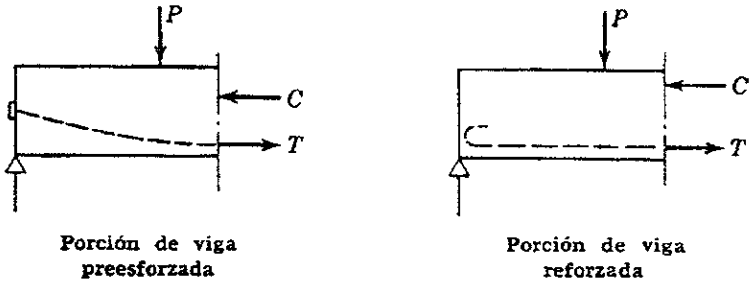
Momento interno resistente en vigas de concreto preesforzadas y reforzadas, respectivamente
